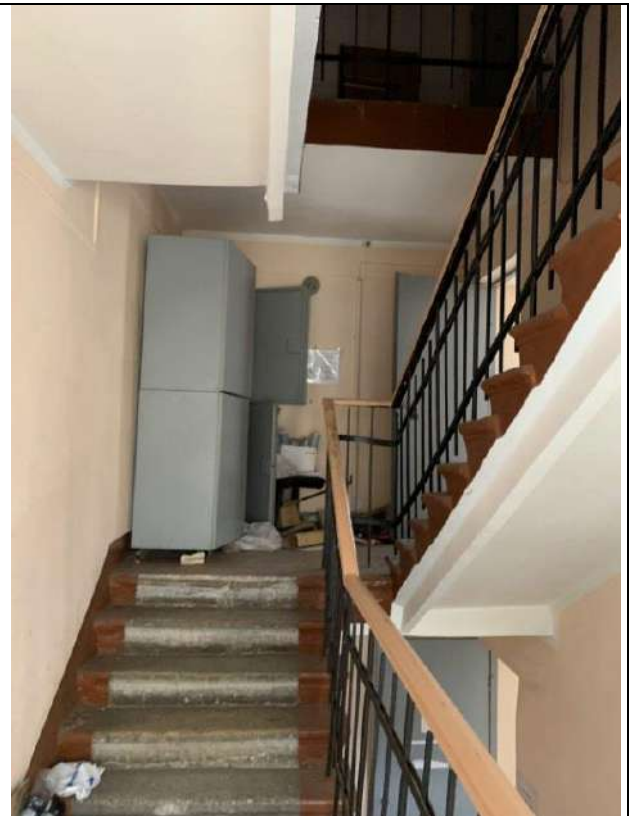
Подход к ч.п. 3-Н, расположенным на 3-м этаже со стороны входа №1
